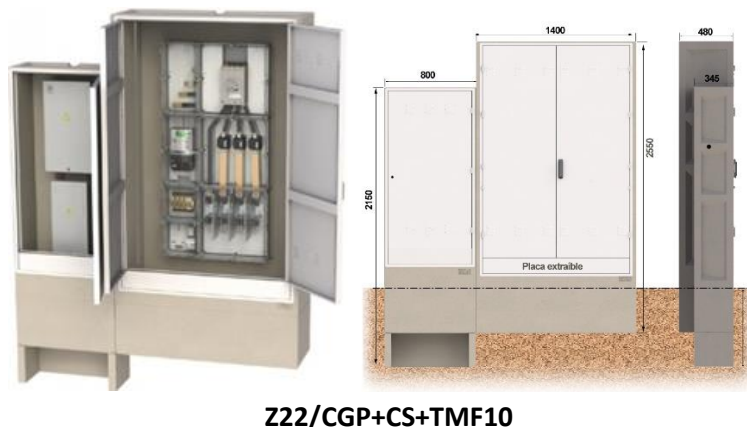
Armario prefabricado de hormigón para albergar la CS, CGP y el conjunto TMF10. Fuente [5.2].
